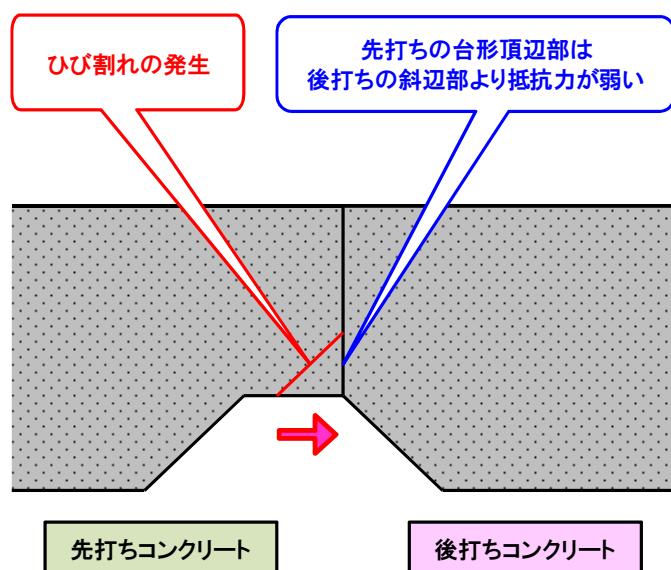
施工目地部が台形形状の場合のひび割れ発生
